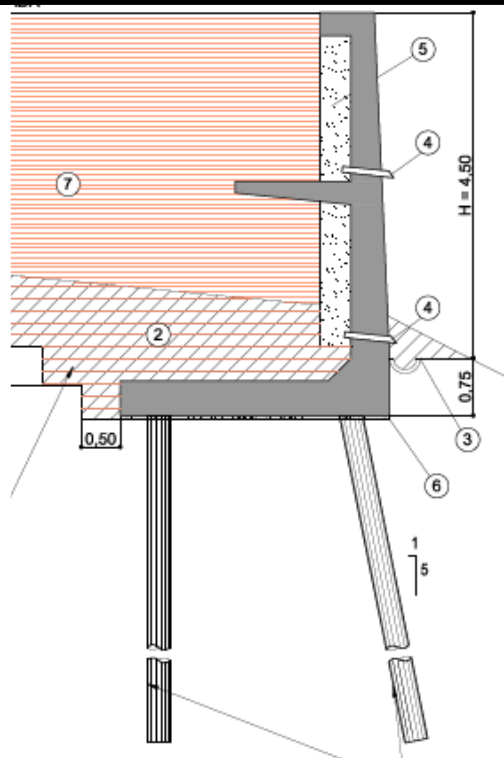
Croquis esquemático da solução em muro de concreto armado à flexão “L” para a altura de até 4,5 m com estabilizador.
